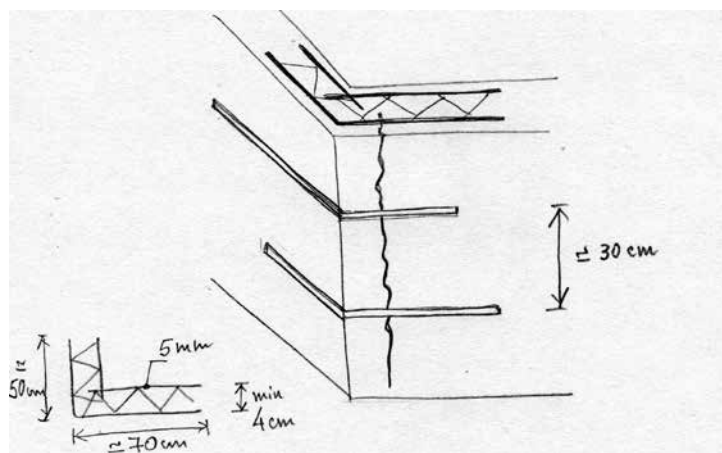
Ilustração esquemática de reabilitação de fissuras - Ficha A2.
